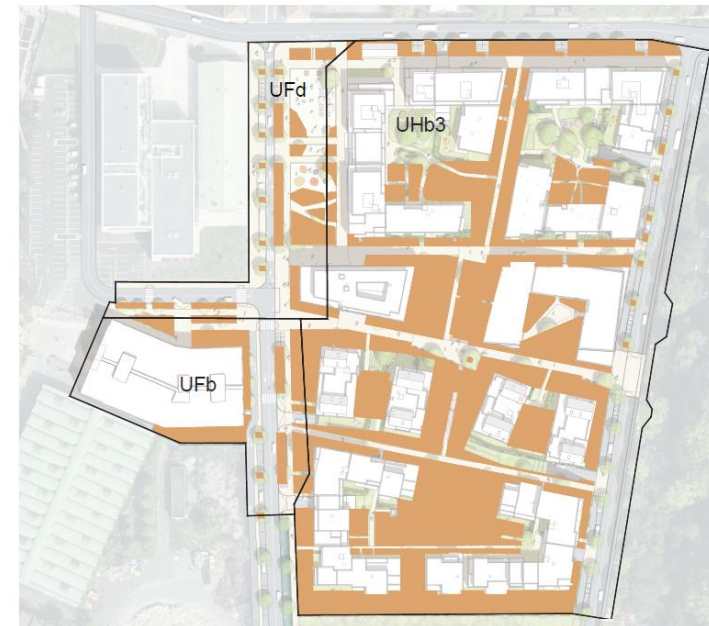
Plans des espaces verts et espaces de pleine terre du projet (Source : Maitrise d'Oeuvre)
